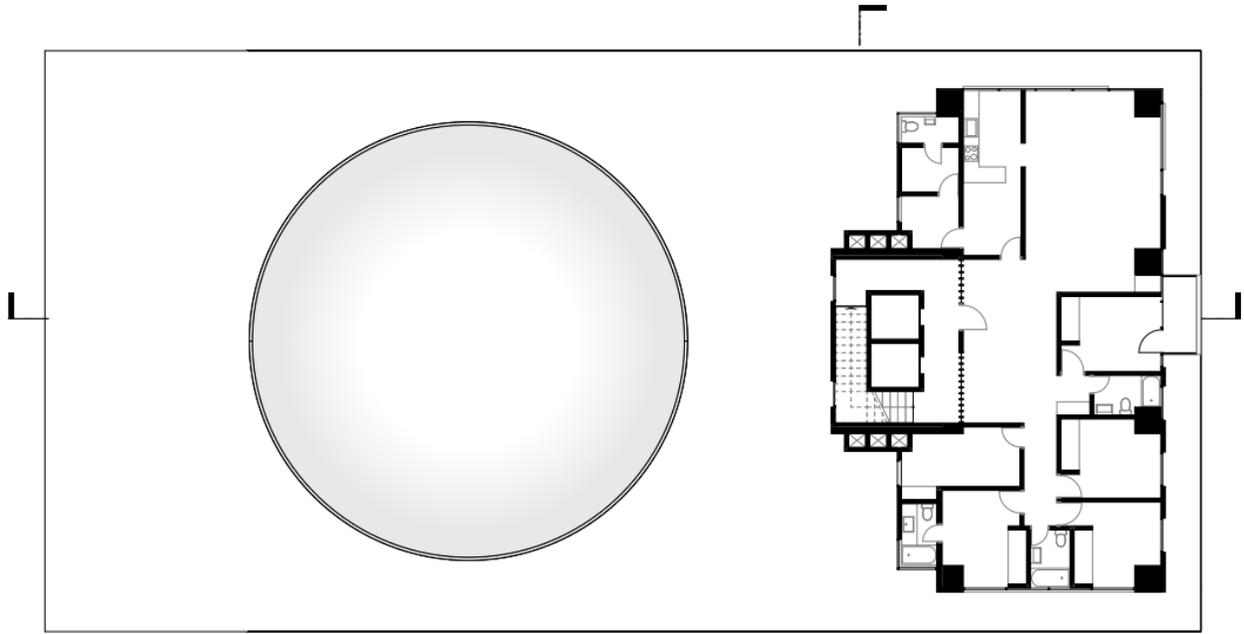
Planta alta actual N+12.50/N+18.50/N+21.50. Fuente: Tesistas.
